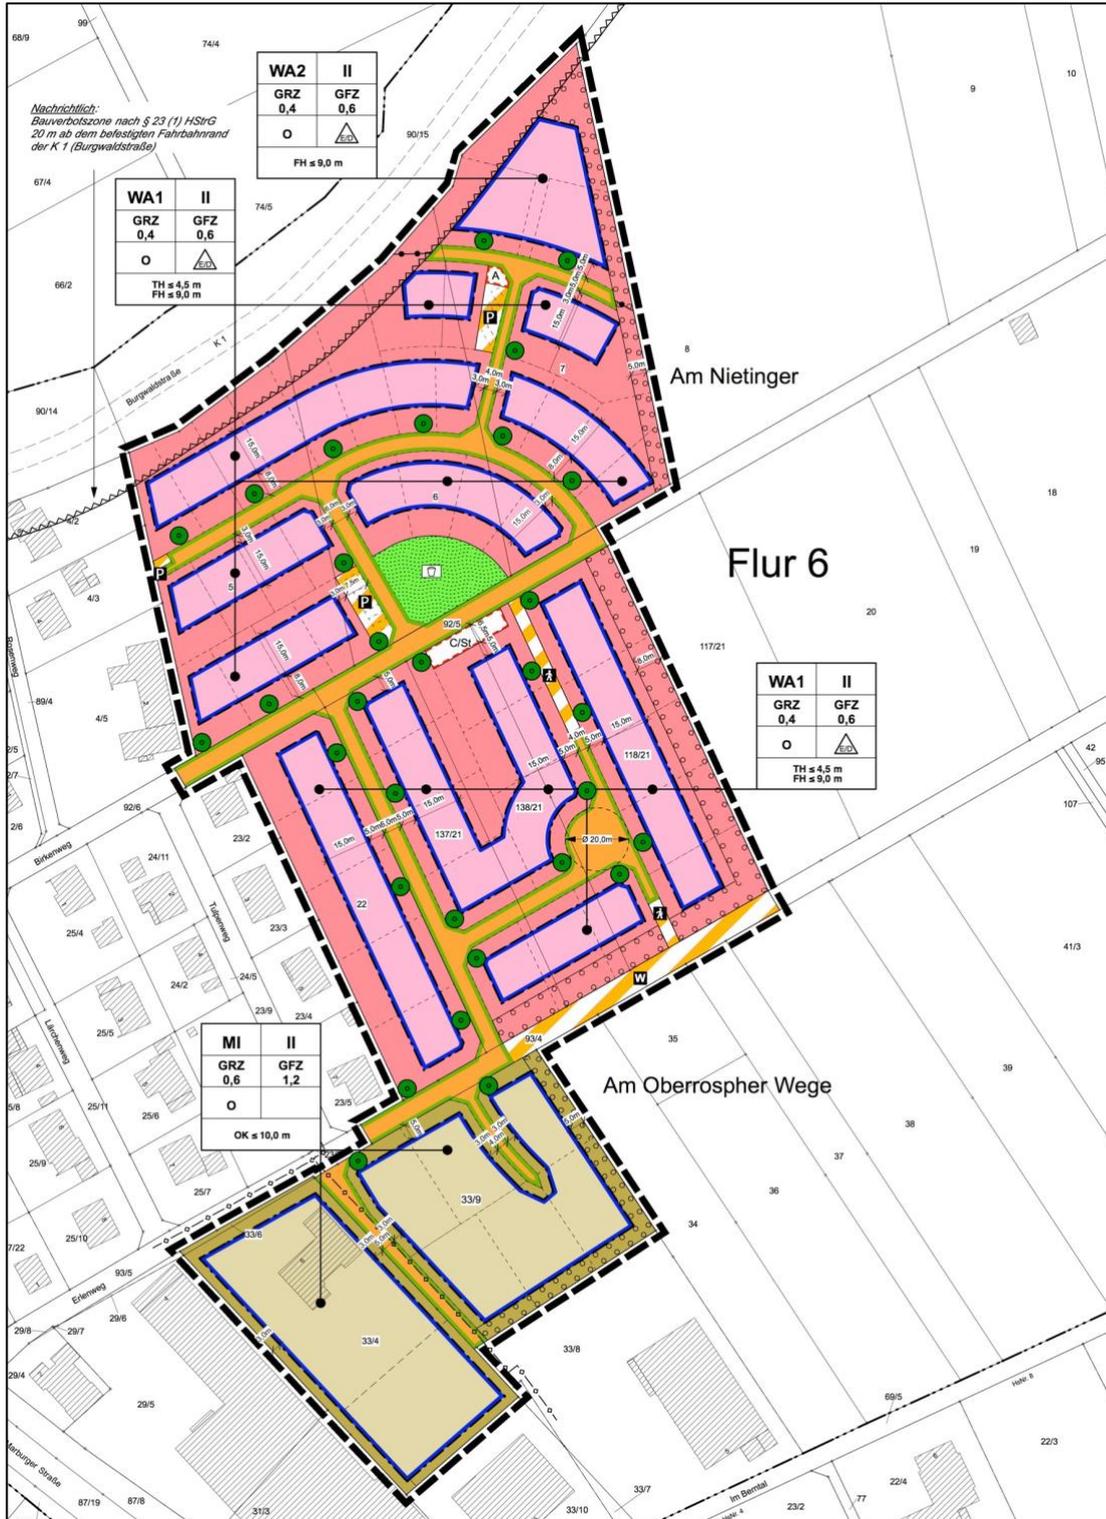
Bebauungsplan "Am Oberrospher Wege" - Ausschnitt Planteil (Teilgeltungsbereich I – Baugebiet)
